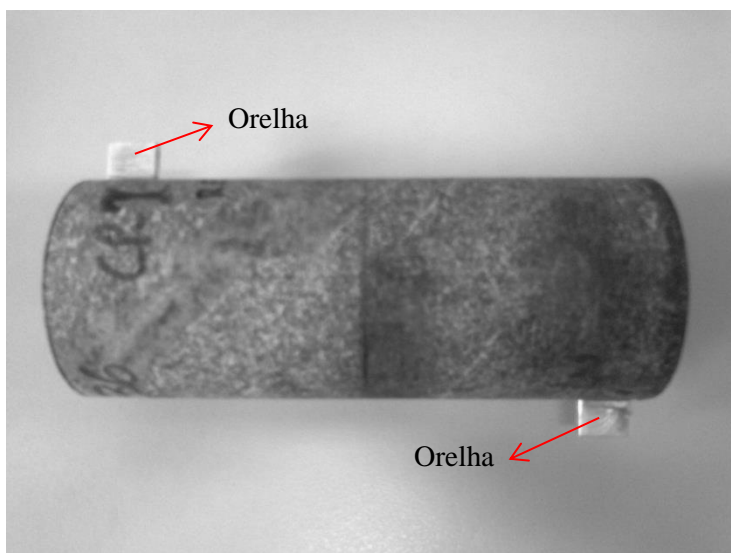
Fixação das “orelhas” em um corpo de prova de concreto no formato cilíndrico.
